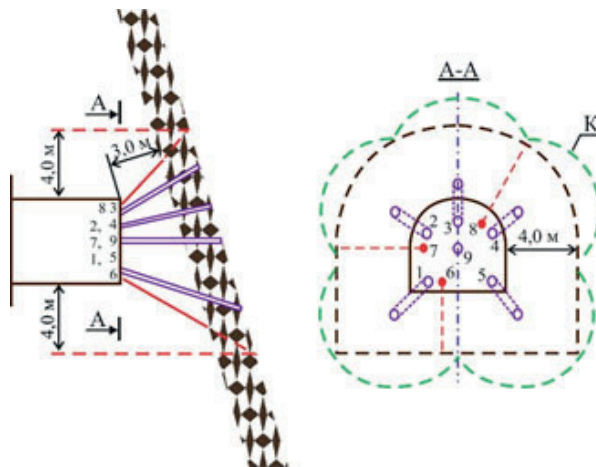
Схема расположения скважин в забое для гидрообработки угольного массива перед вскрытием пласта: 1–5 – увлажняющие скважины; 6 – контрольная скважина
